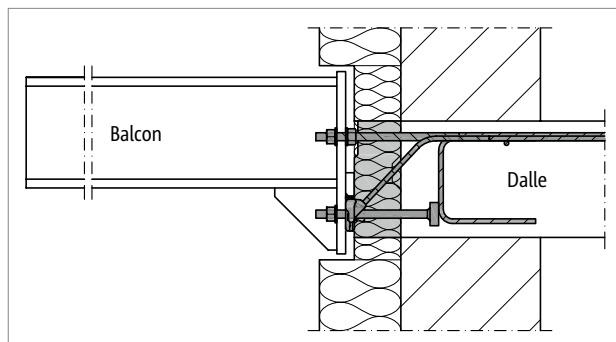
Schöck Isokorb® T type SK : Transition sans obstacle grâce au décalage en hauteur
